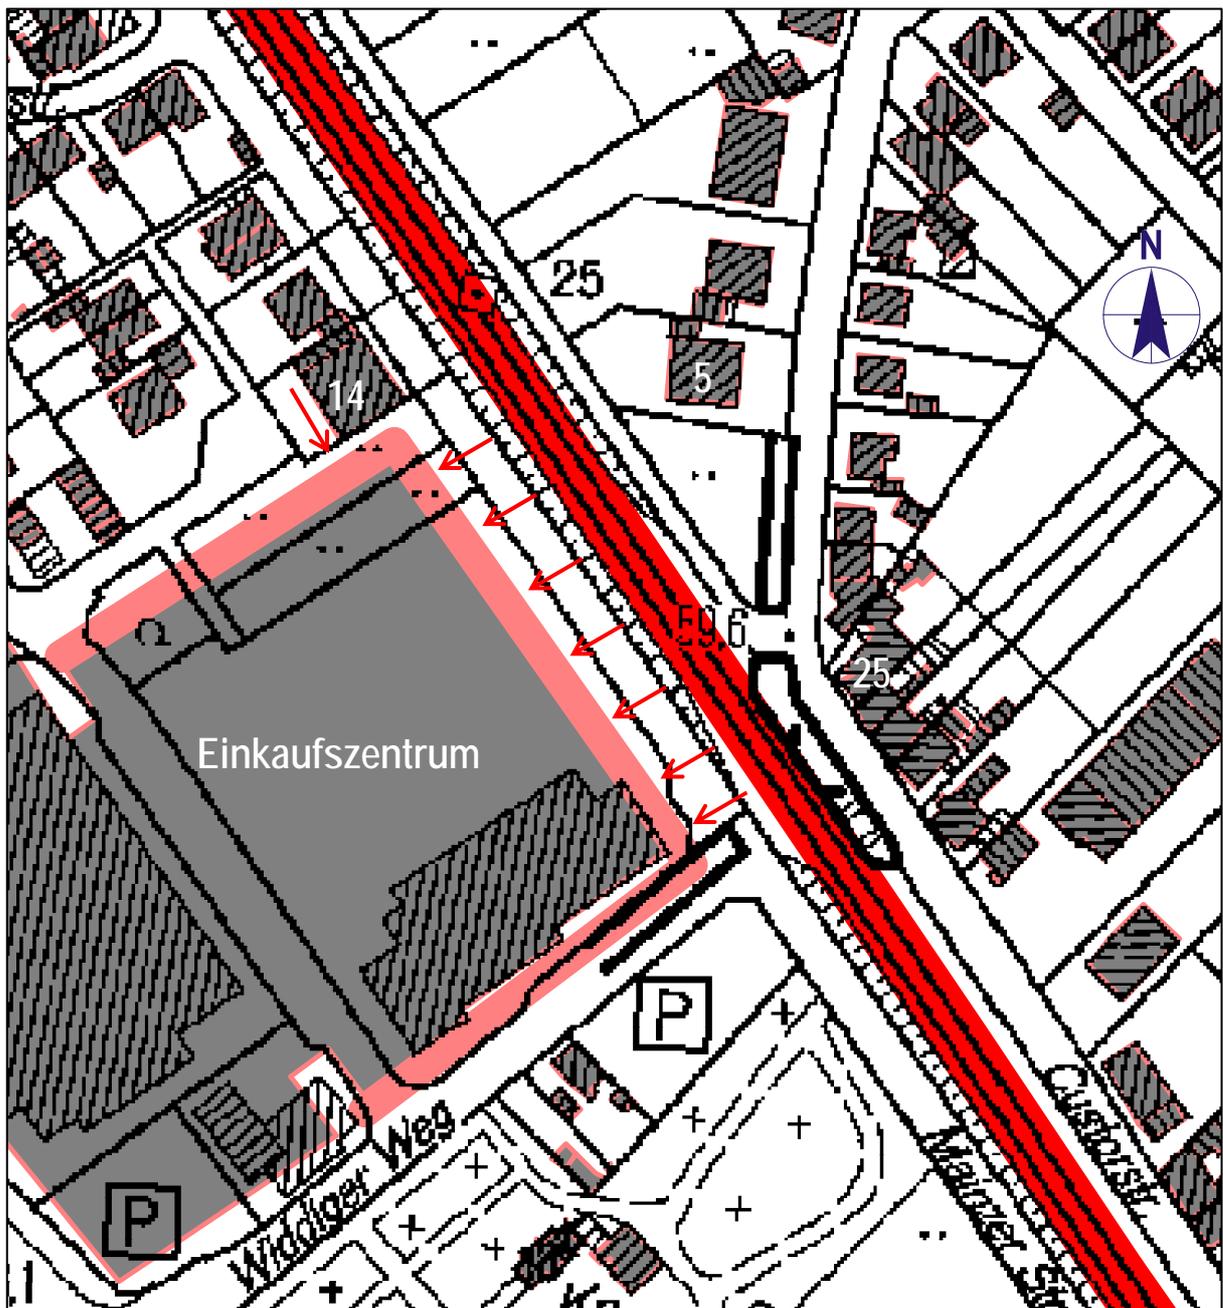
Bestandsplan, geplantes EKZ-Gebäude, Bahntrasse (rote Linie) und reflektierende Flächen (rosa) markiert, Maßstab 1:1.500
